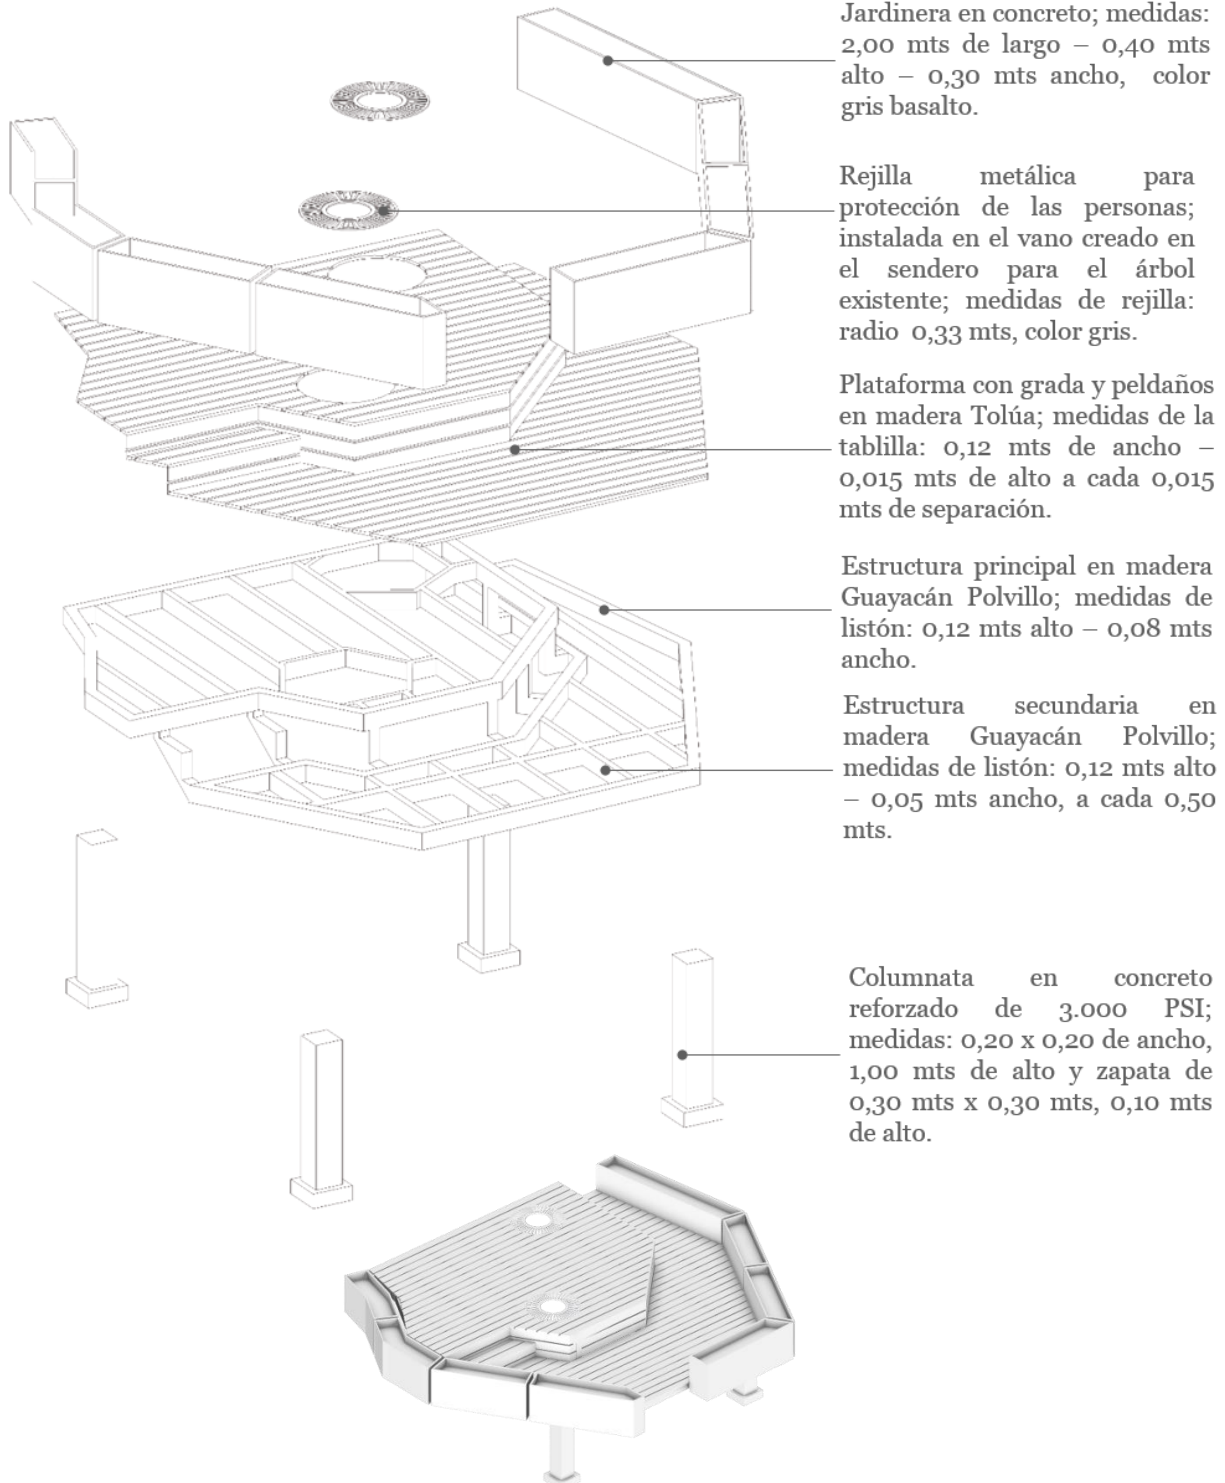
Despiece y perspectiva de mirador 2. Fuente: grupo de investigación.
